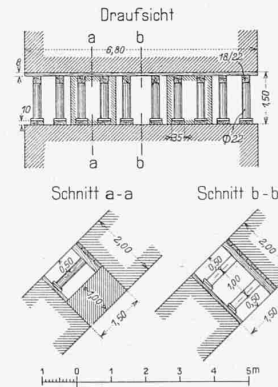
Abspriessung und stufenweise Betonierung der Schlussabteilung 9. Masstab 1 : 200.
